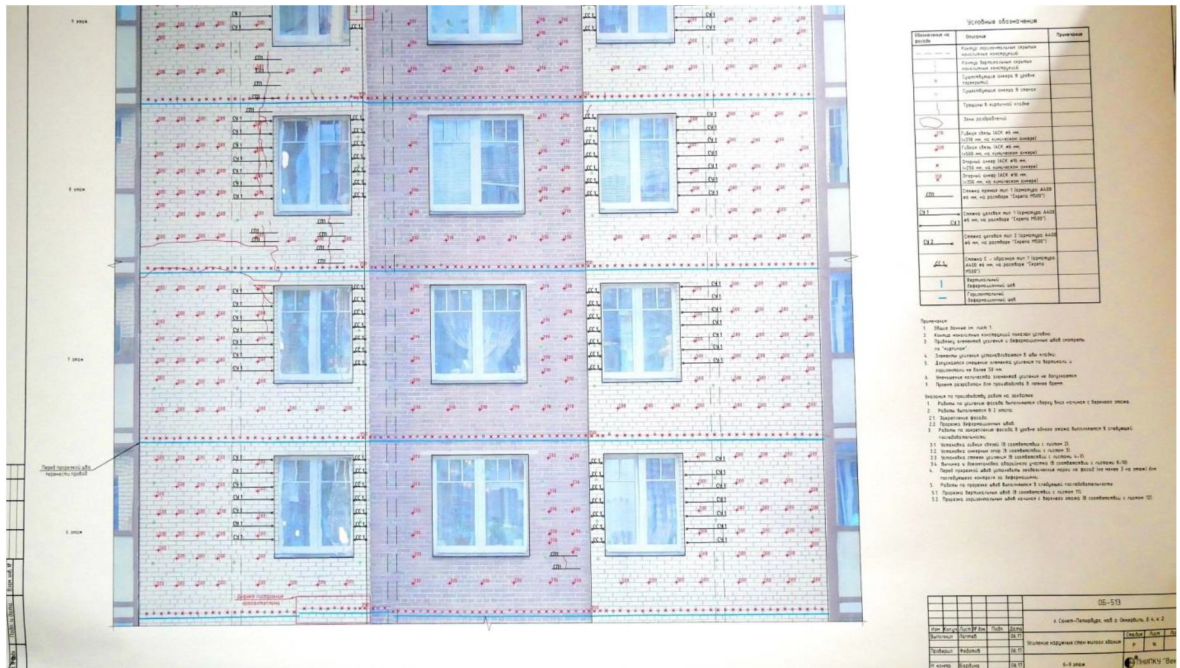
Лист з проекту посилення фасаду житлового будинку.
